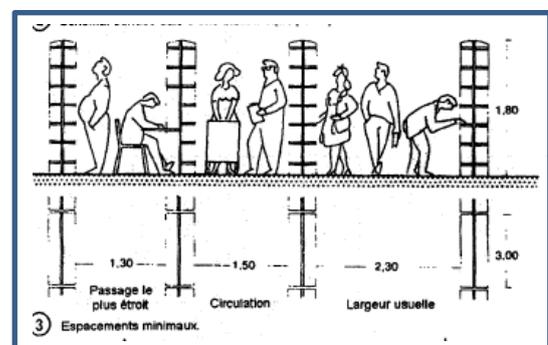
dimensionnement De la bibliothèque (Source : les éléments des projets de construction p282)
